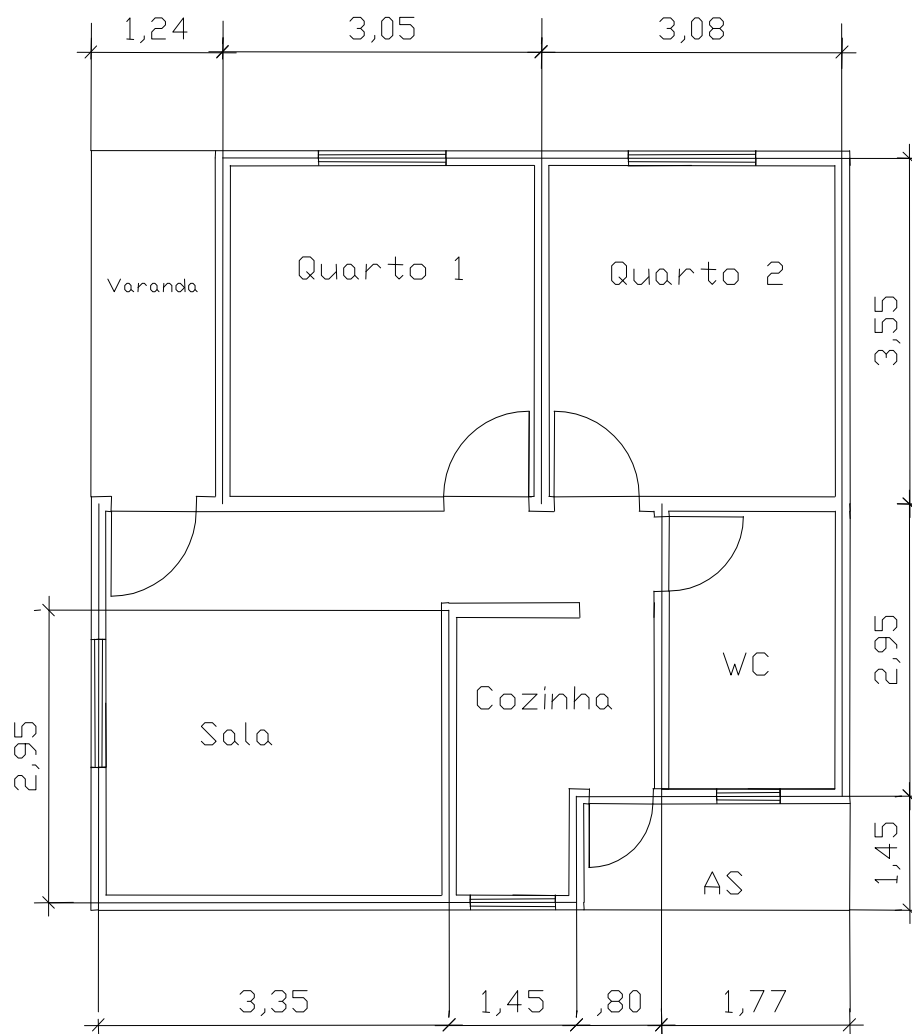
Planta da casa estudada. Medidas em m. Planta sem escala.
